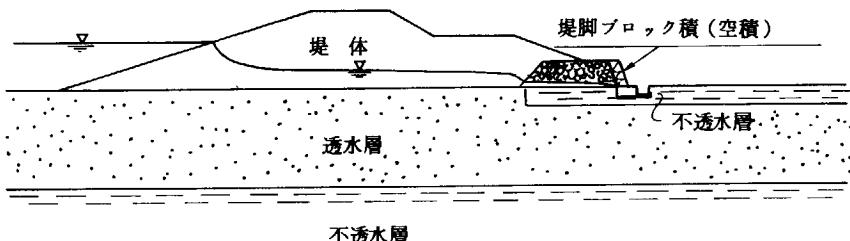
堤体裏のり部の排水機能を持つ堤脚工法
